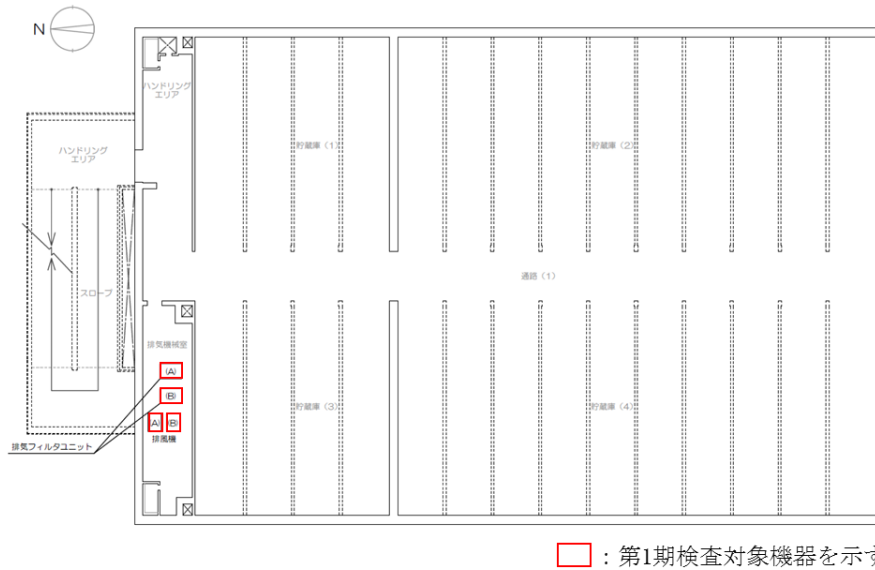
確認事項の対象となる機器の配置を示した図 3階平面図 (4/6)
